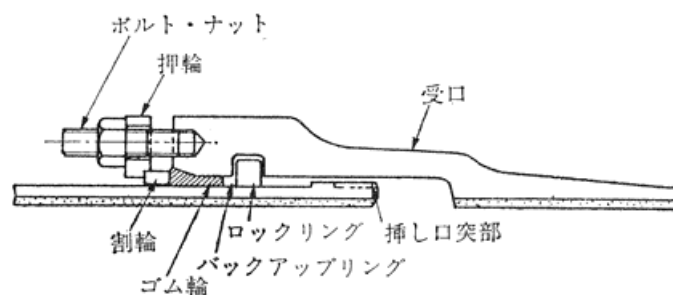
受口・挿し口の挿入完了 (単位: mm)
